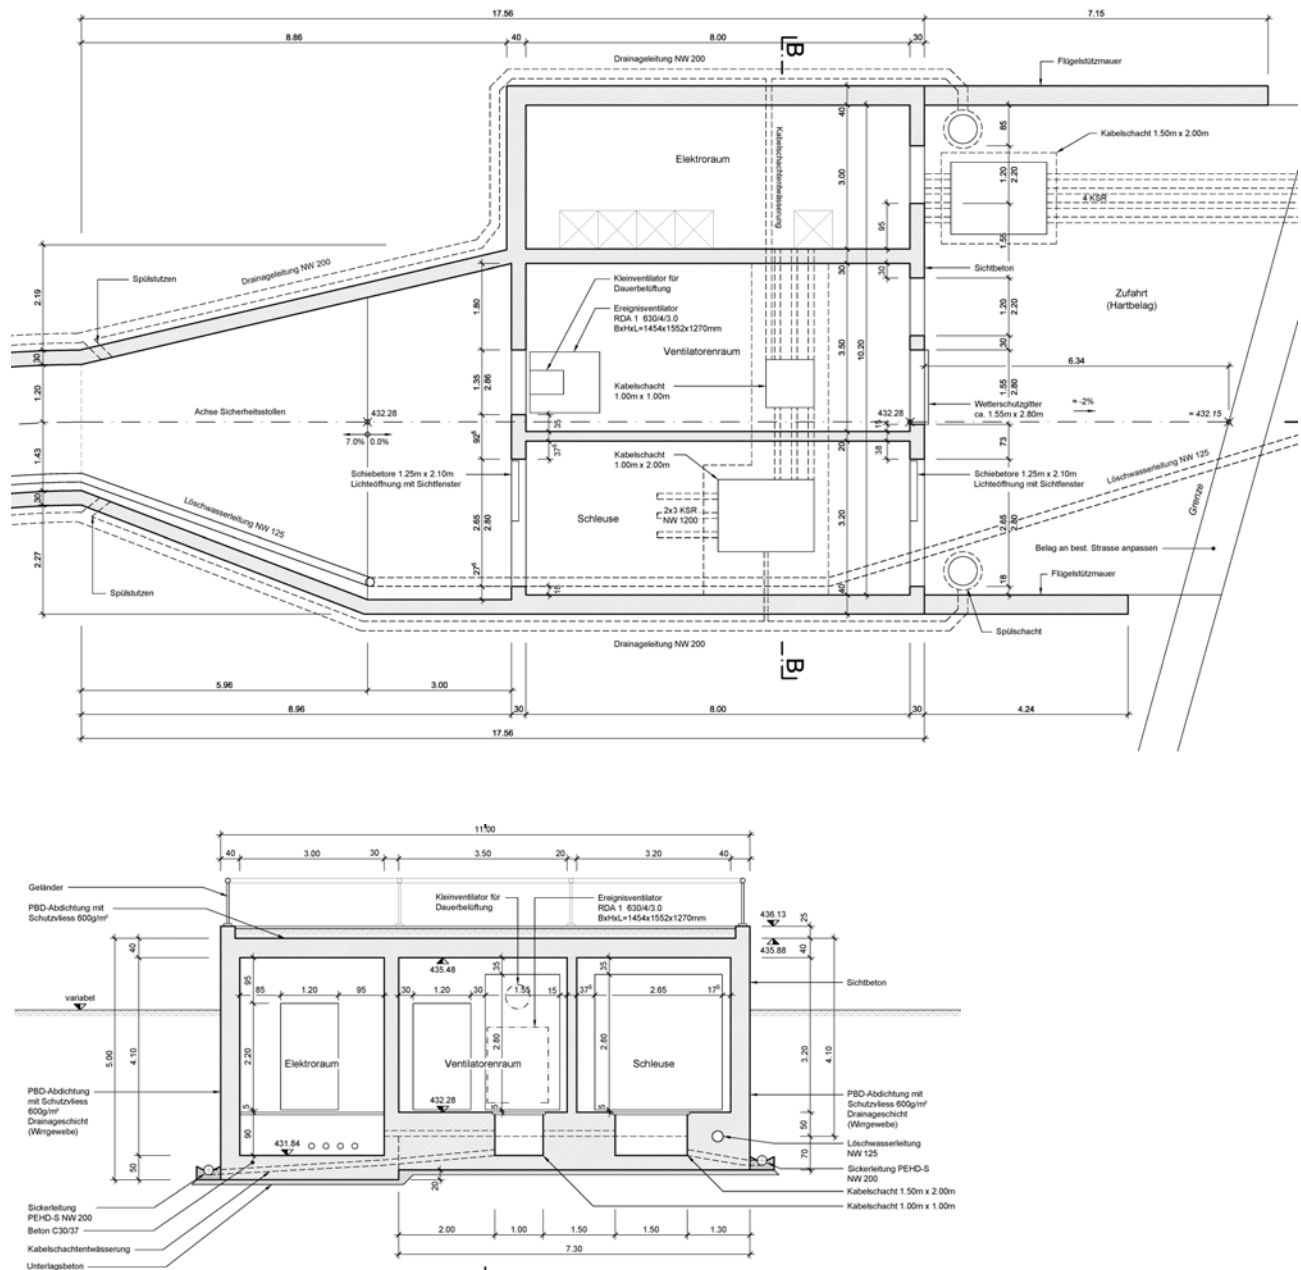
Skizze Grundriss und Querschnitt Portalstation SISTO (siehe auch Plan TU.115)
